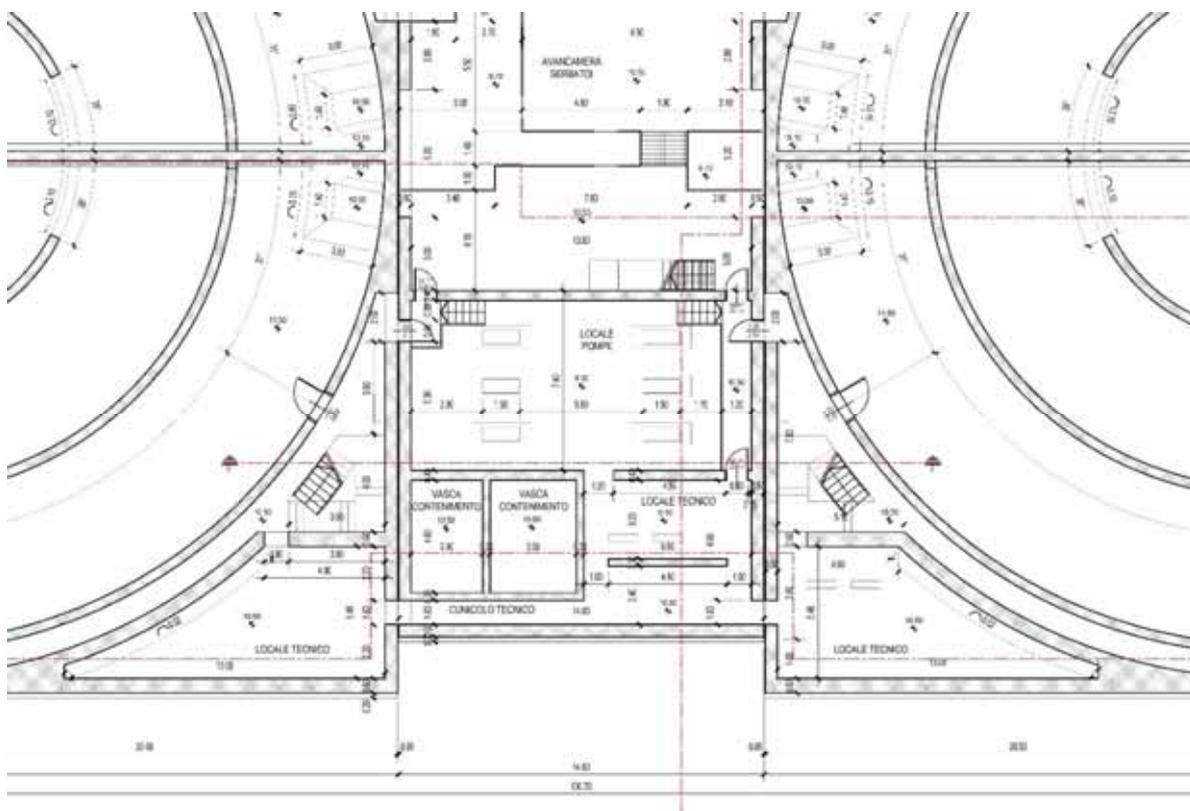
Estratto della pianta del piano interrato del serbatoio (estratto dal Progetto Definitivo).
